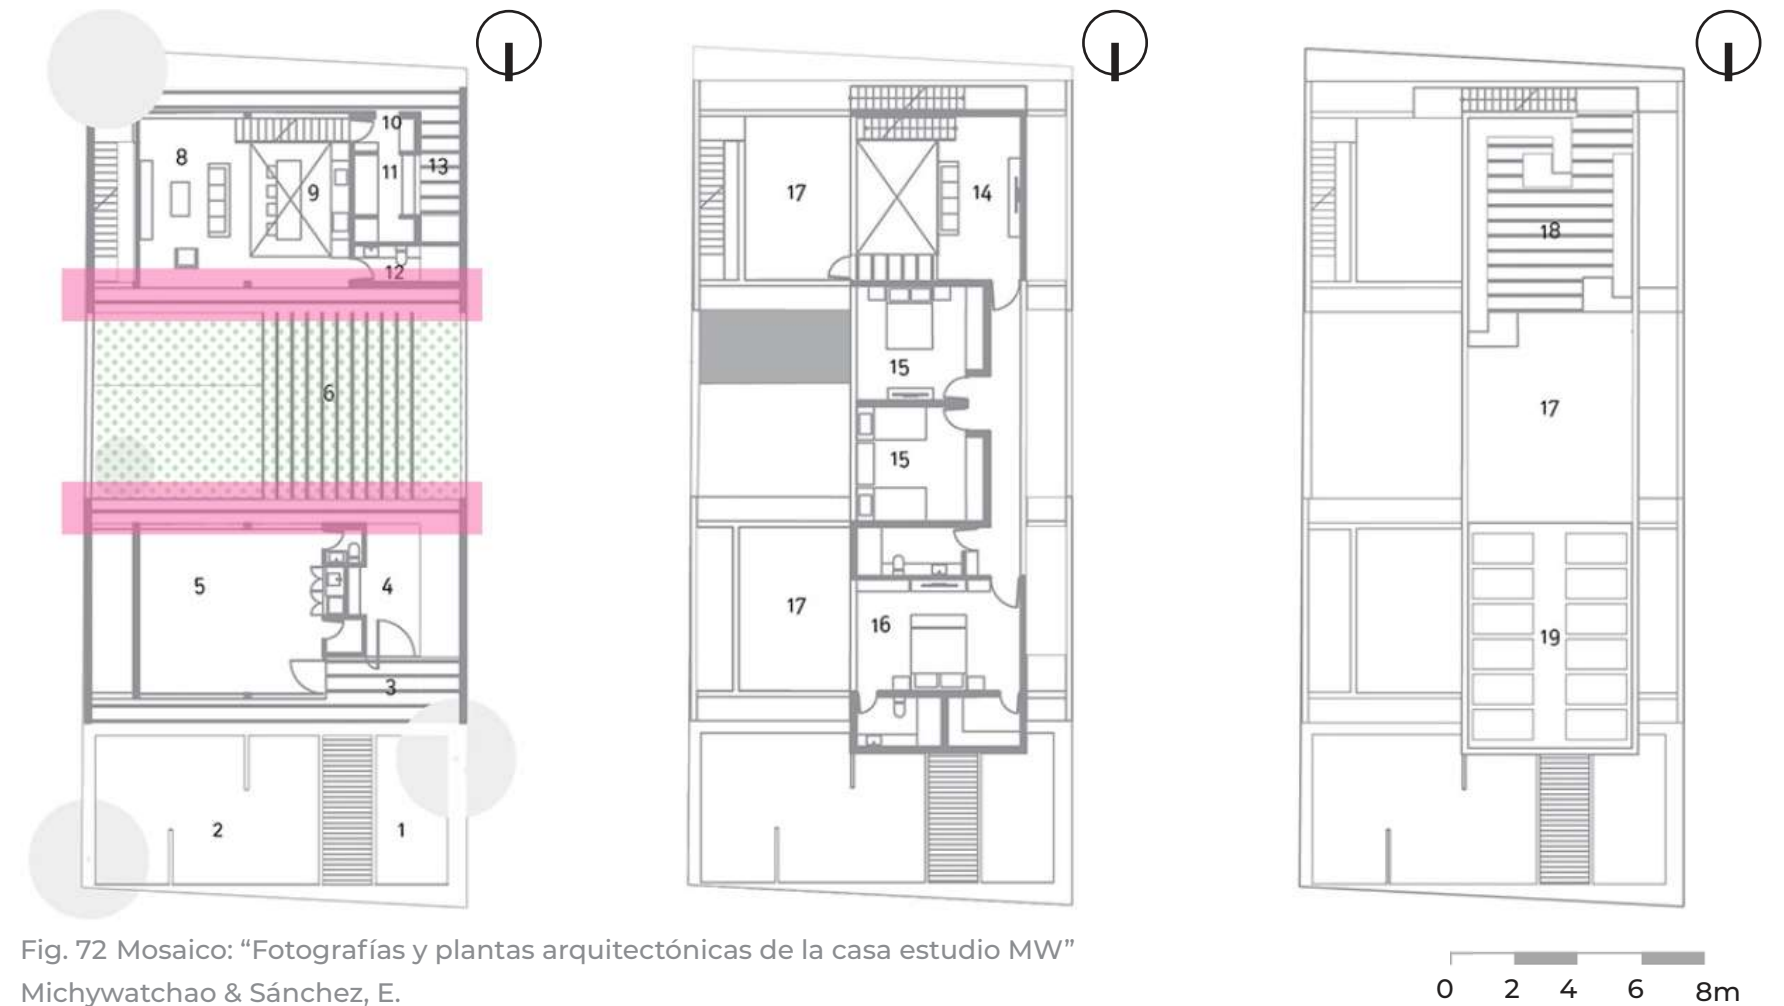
Mosaico: “Fotografías y plantas arquitectónicas de la casa estudio MW”
